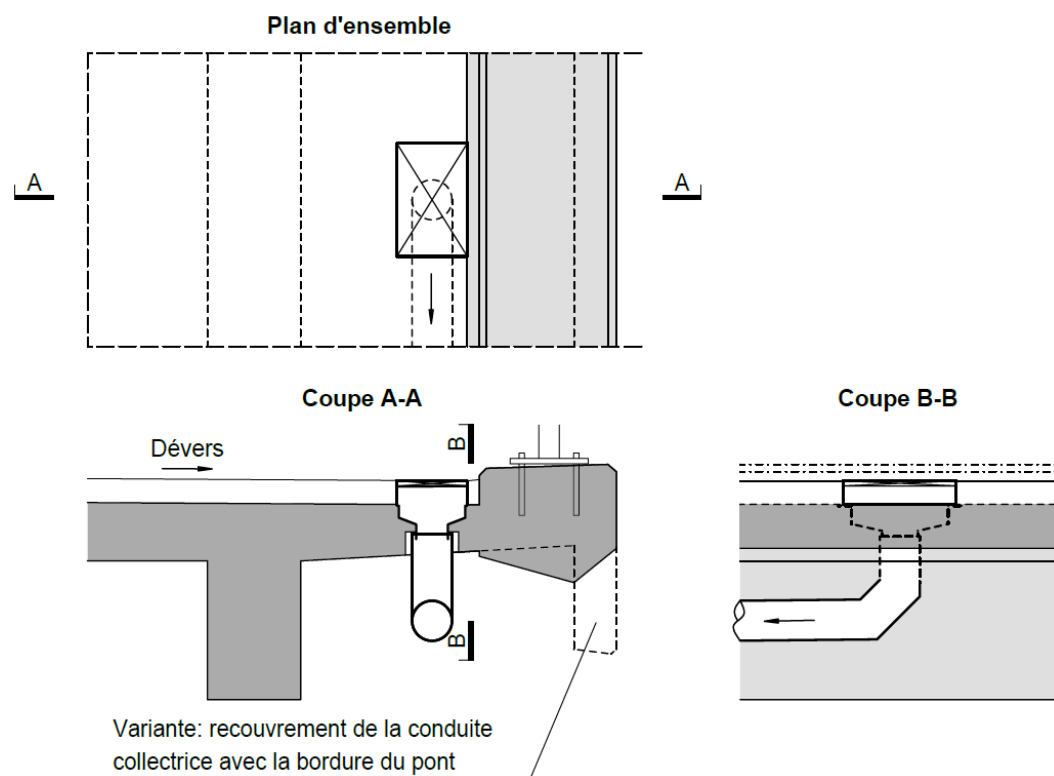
Conduite collectrice sous le porte-à-faux
